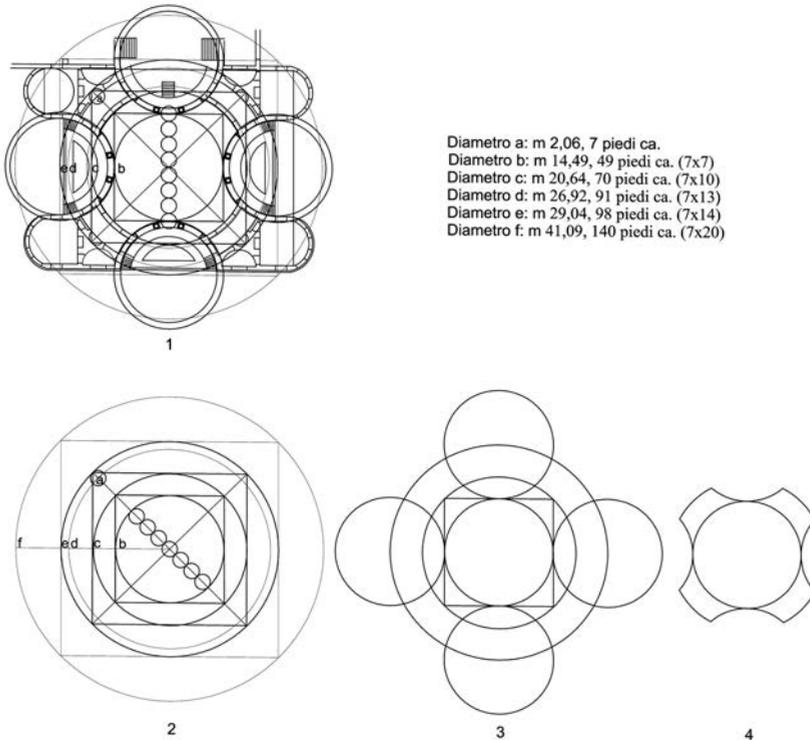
Villa Adriana, Accademia, Atrio Mistilineo, planimetria, schema metrico e geometrico alla base del progetto (autore).
